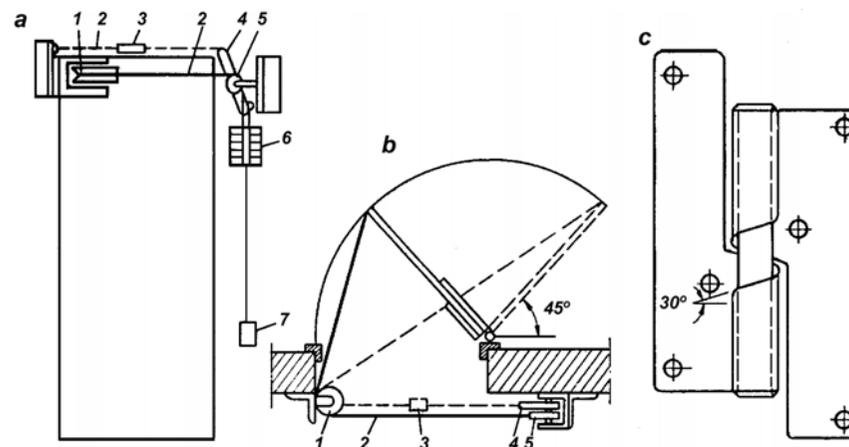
Механизмы самозакрывания однопольных навесных дверей: а, б — с помощью грузов; с — с помощью винтовых дверных петель; 1 — горизонтальный ролик; 2 — трос; 3 — легкоплавкий замок; 4 — рычаг; 5 — вертикальный ролик; 6 — большой противовес; 7 — малый противовес.
